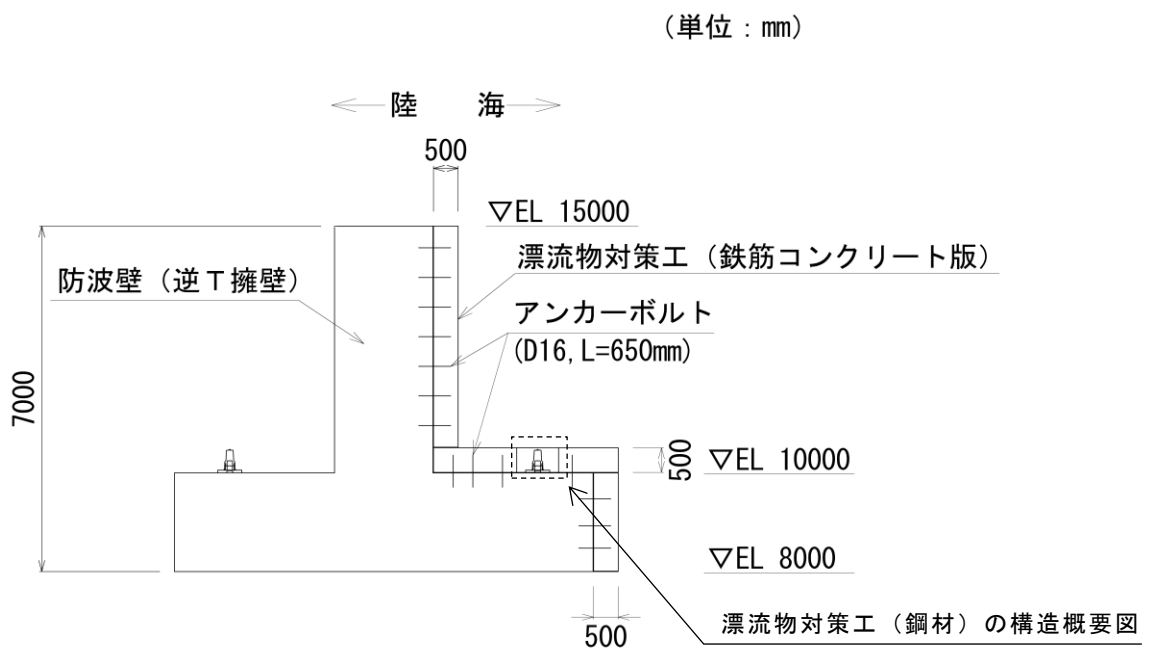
(2) 漂流物対策工 (鉄筋コンクリート版) のアンカーボルト配置図 (断面図)
